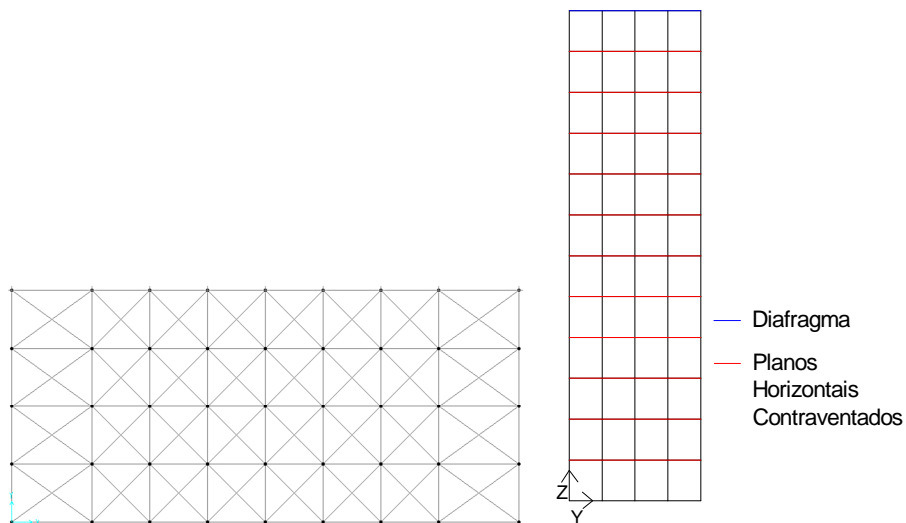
Configuração dos Planos de Contraventamento Horizontal Com Elementos de Contraventamento Pequenos
